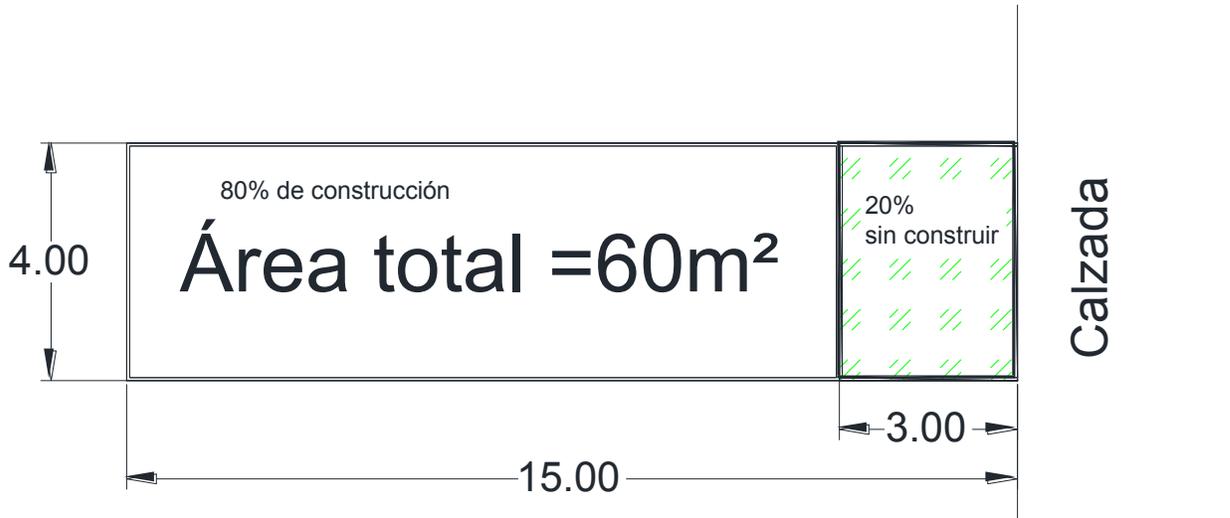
Vista en planta de lote tipo de acuerdo a Plan Municipal.
